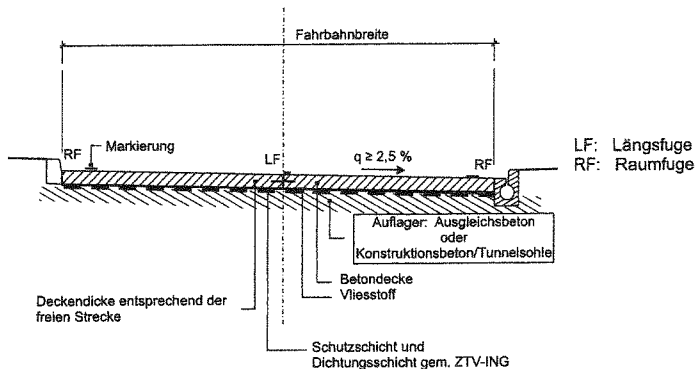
Sonderausführung – Betondecke in einem Tunnel-/Trogbauwerk direkt auf dem Ausgleichsbeton oder Konstruktionsbeton/Tunnelsohle aufgelagert – Querschnitt
